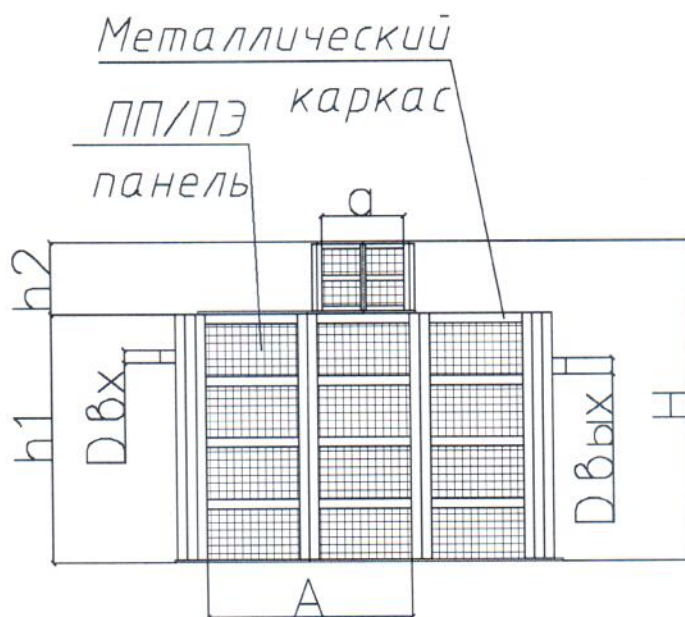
Общий вид одного корпуса НС в металлическом каркасе с пластиковыми панелями.
